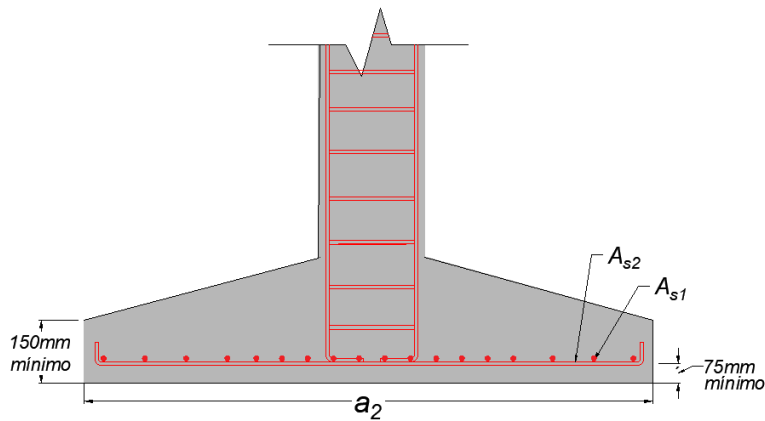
Doblado del extremo libre de las barras de la columna orientado hacia adentro
